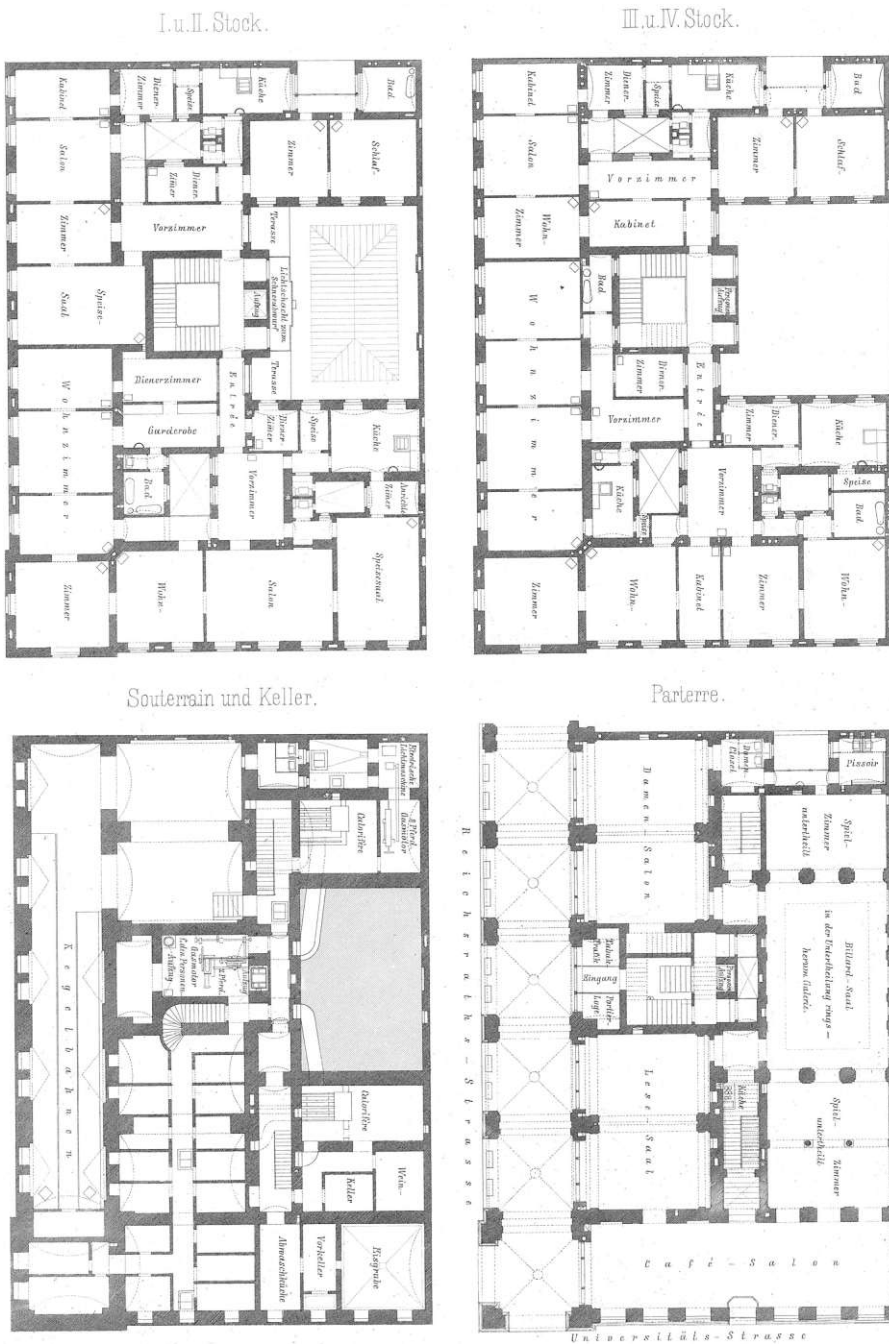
Grundrisse Wohnhaus Ecke Universitätsstraße und Reichsrathsstraße - Ludwig Tischler, 1883
